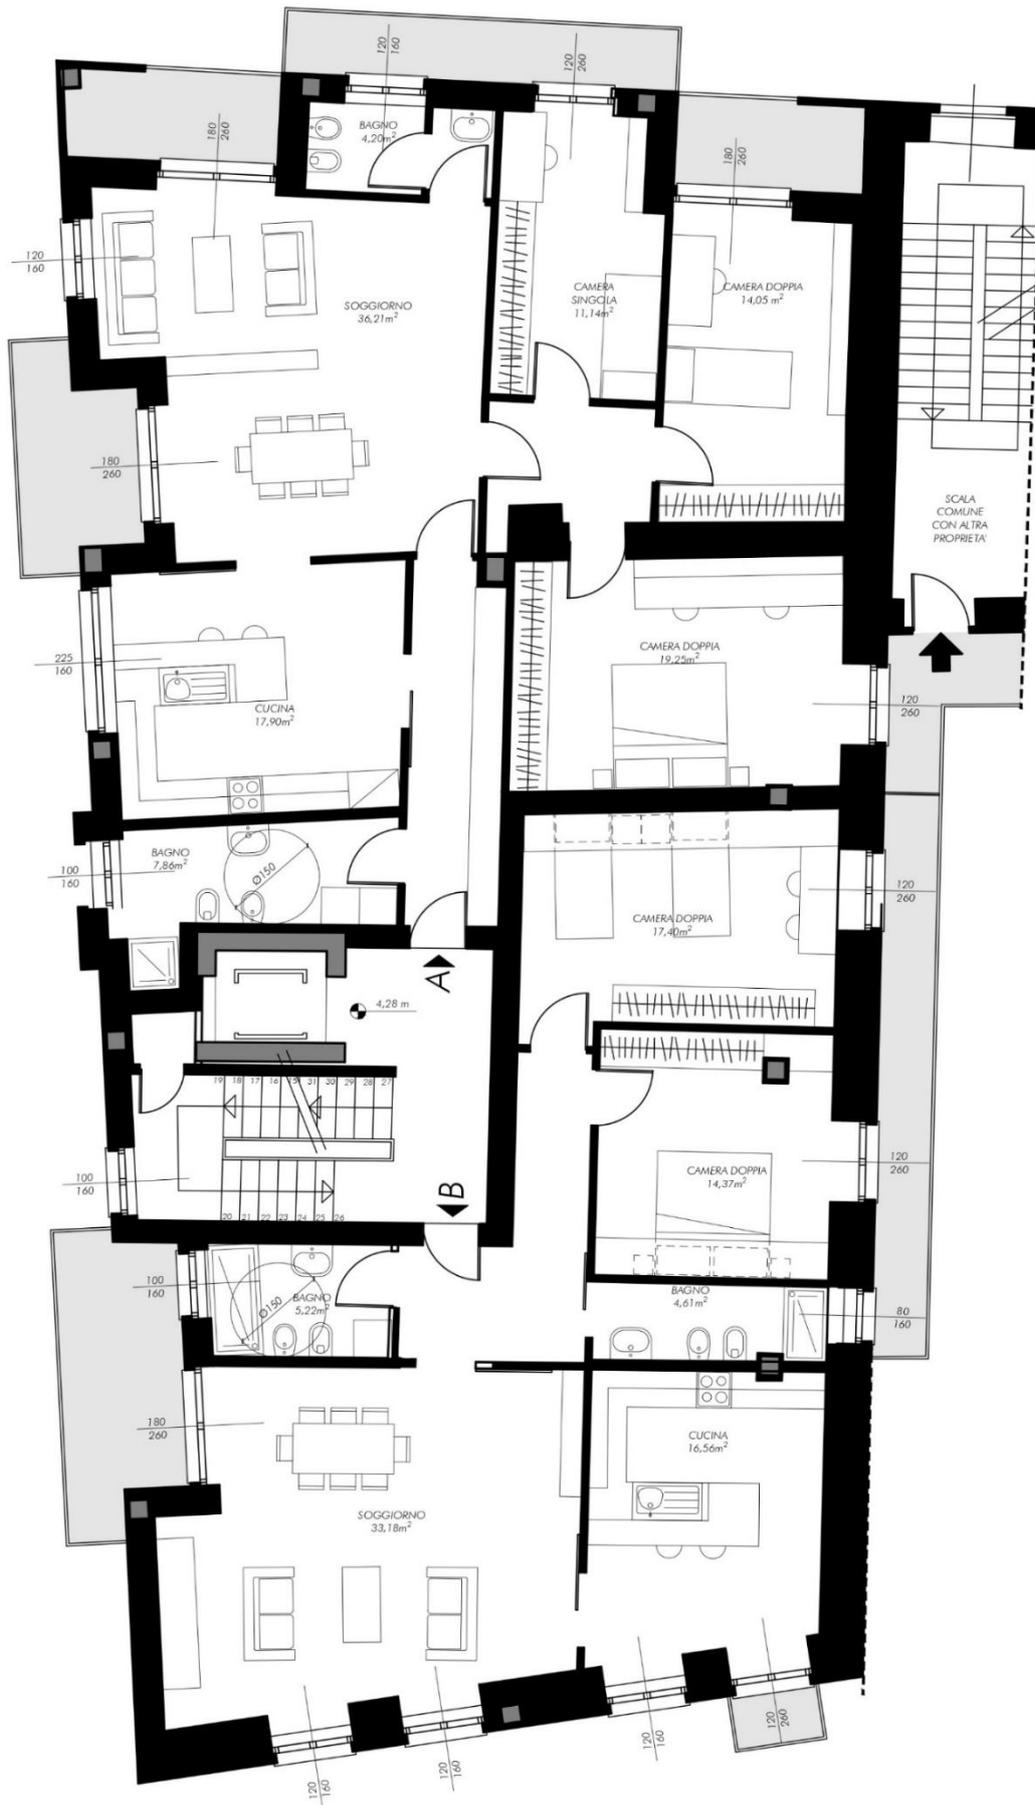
Alternativa di progetto, suddivisione appartamento C studio e trilocale
